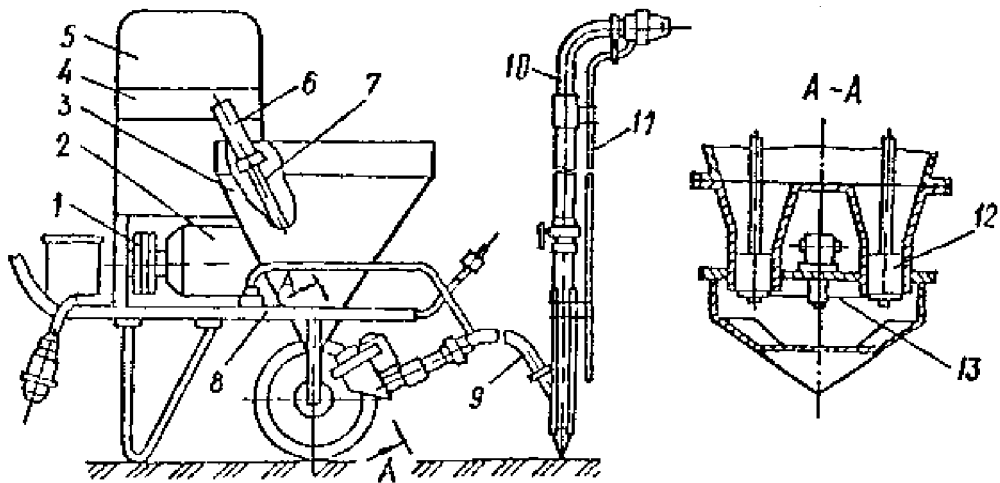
Шпаклювальний агрегат АНШ-1-1:
